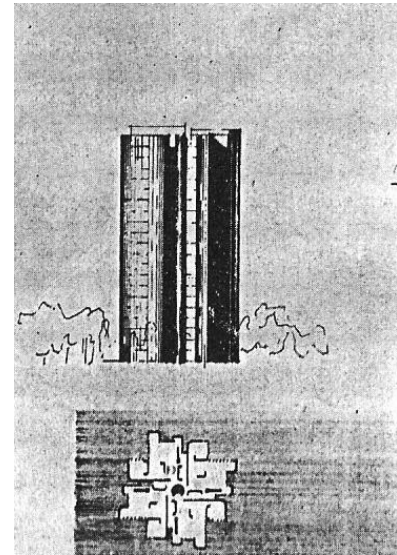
esquema de planta simplificado e imagen de la torre como extrusión de la planta
